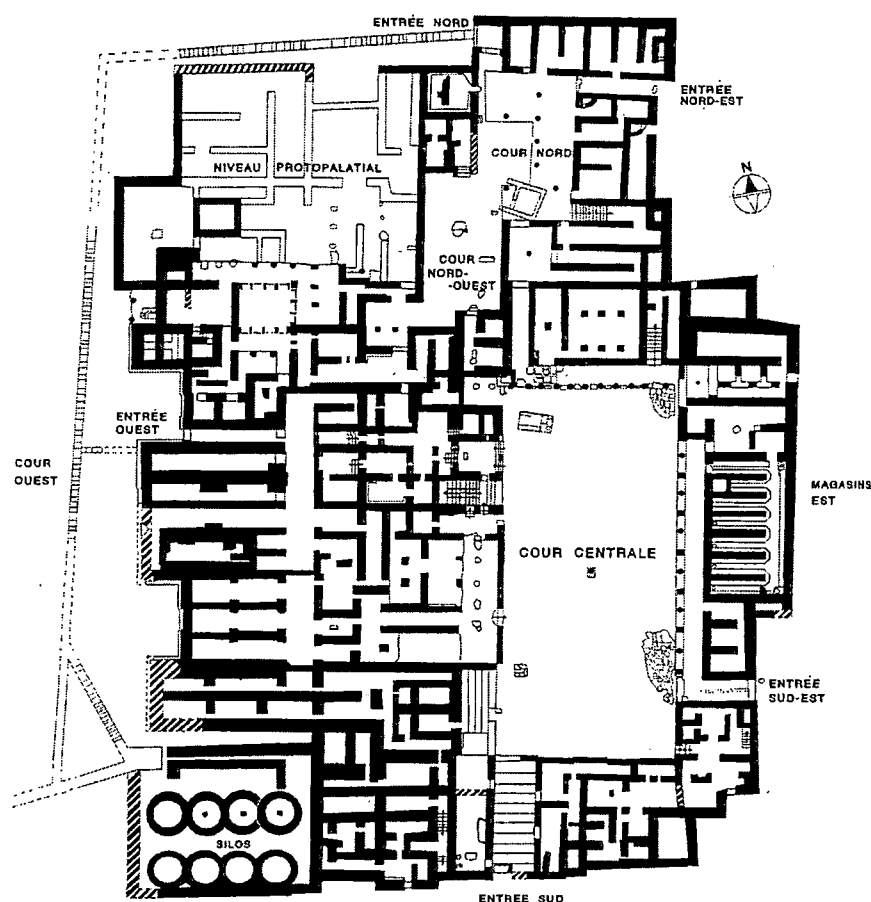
Plan du palais de Malia, d'après Pelon 2002, pl. XXXII.
